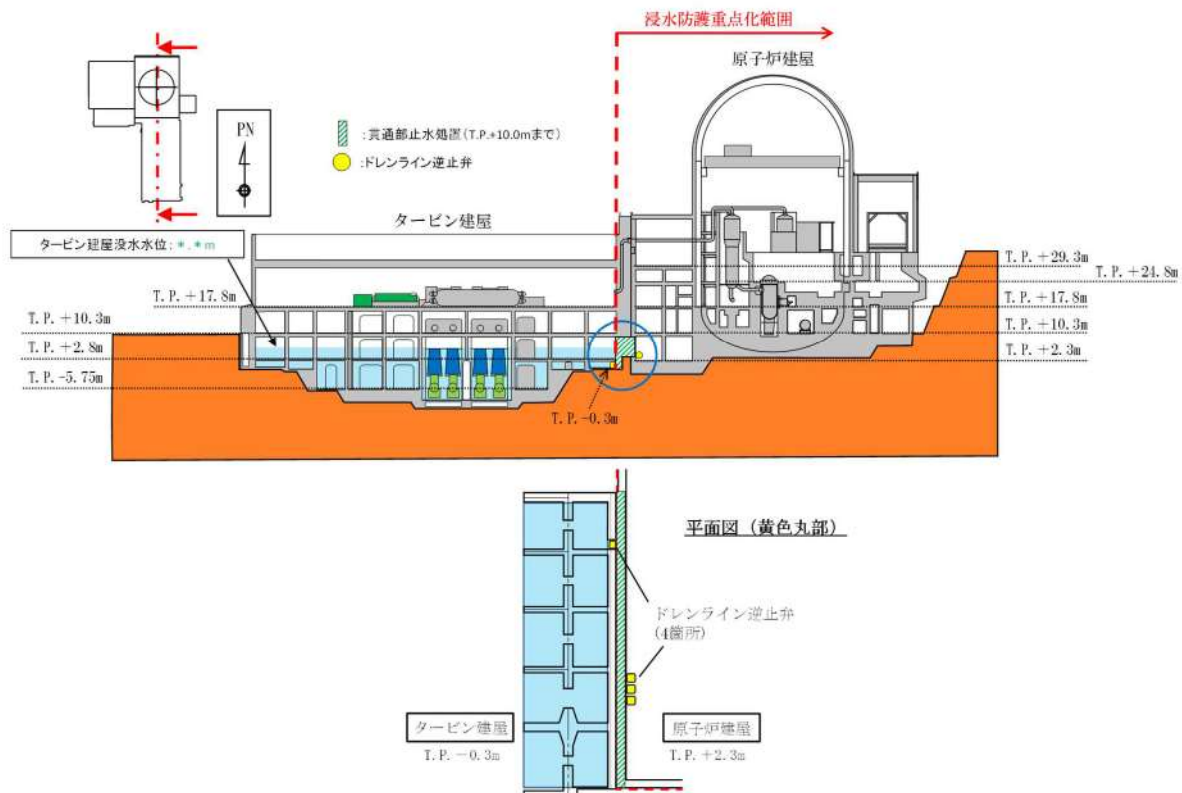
3号炉原子炉建屋と3号炉タービン建屋の境界に設置するドレンライン逆止弁の配置図
